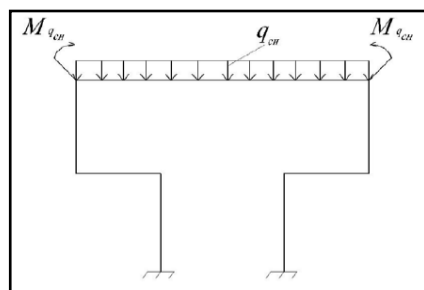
Розрахункова схема поперечної рами для снігового навантаження
